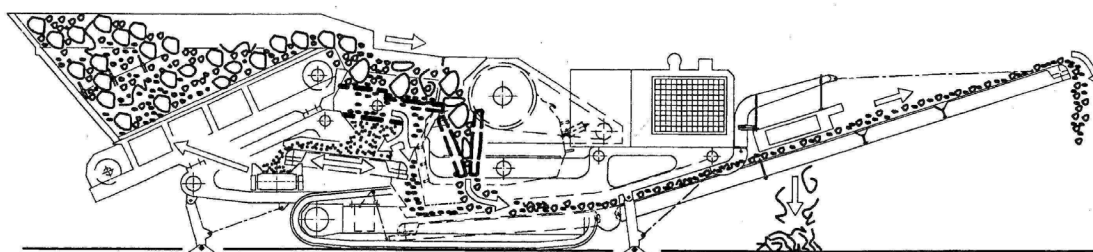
schema di funzionamento della macchina in assetto da lavoro
